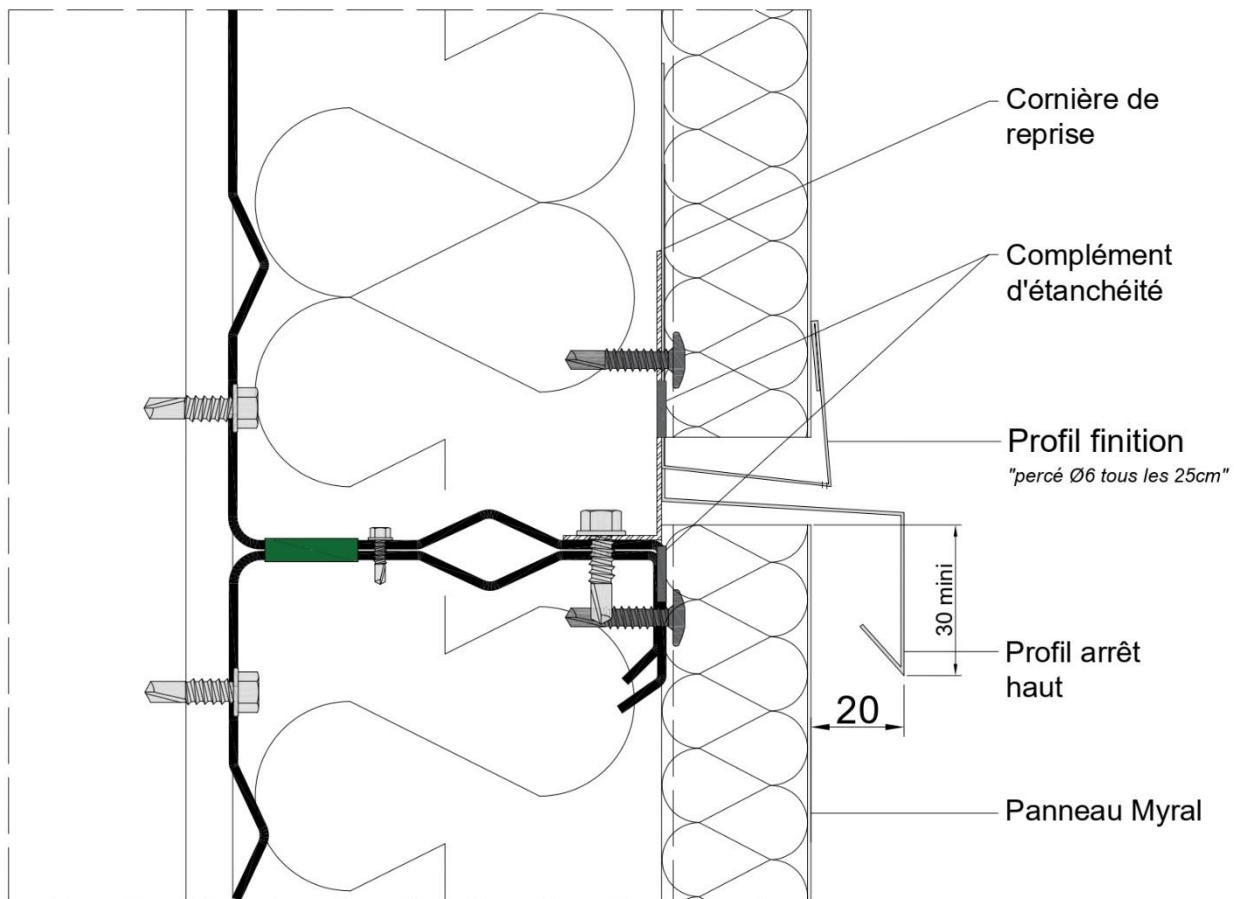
Raccord horizontal avec profils – lame verticale (coupe verticale)
